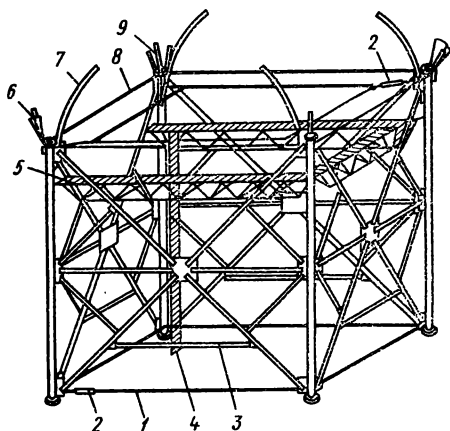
Схема разбивки конструкции башни на монтажные блоки
